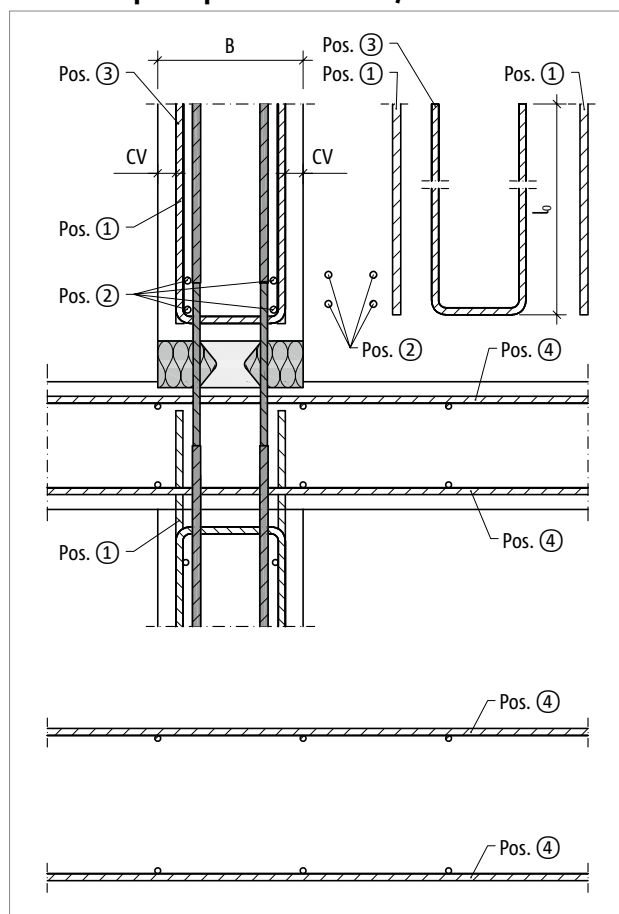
Schöck Sconnex® type W-VH-L : renforcement sur site dans le cas d'un ancrage de l'effort de traction
